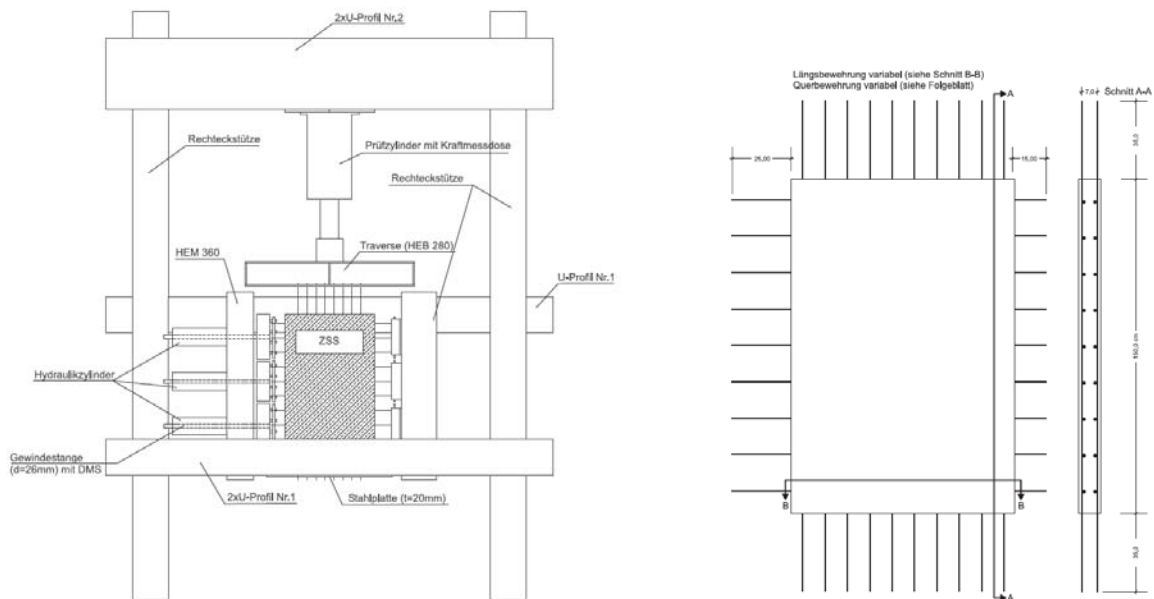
Versuchsaufbau (links) und Bewehrung (rechts) nach Purainer [22]
